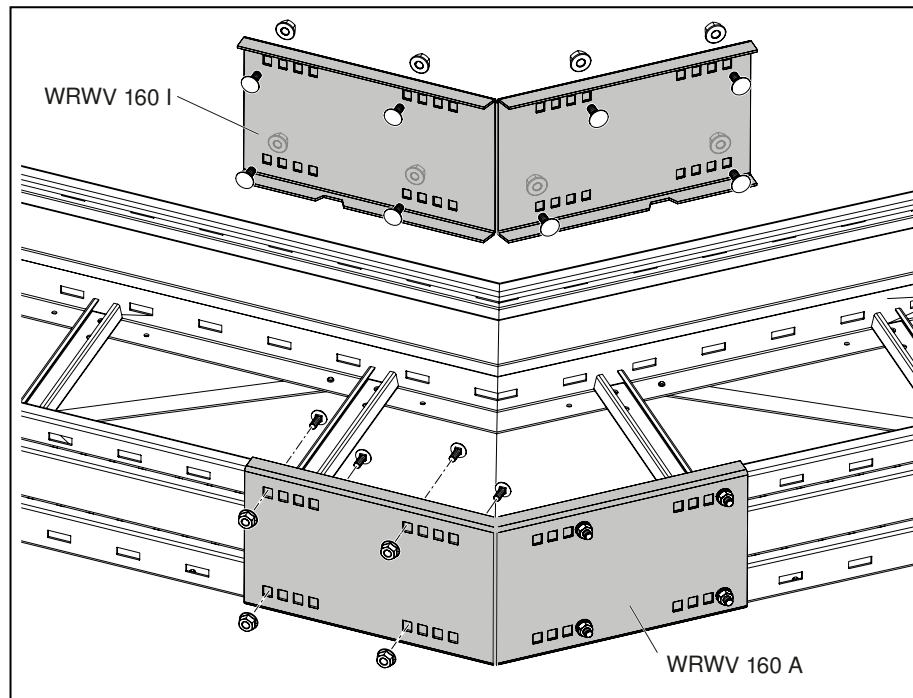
Winkelverbinder WRWV an äußeren und inneren Holm schrauben
